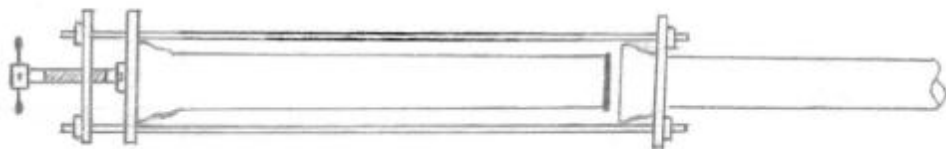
Типы монтажных приспособлений и схемы монтажа труб.
